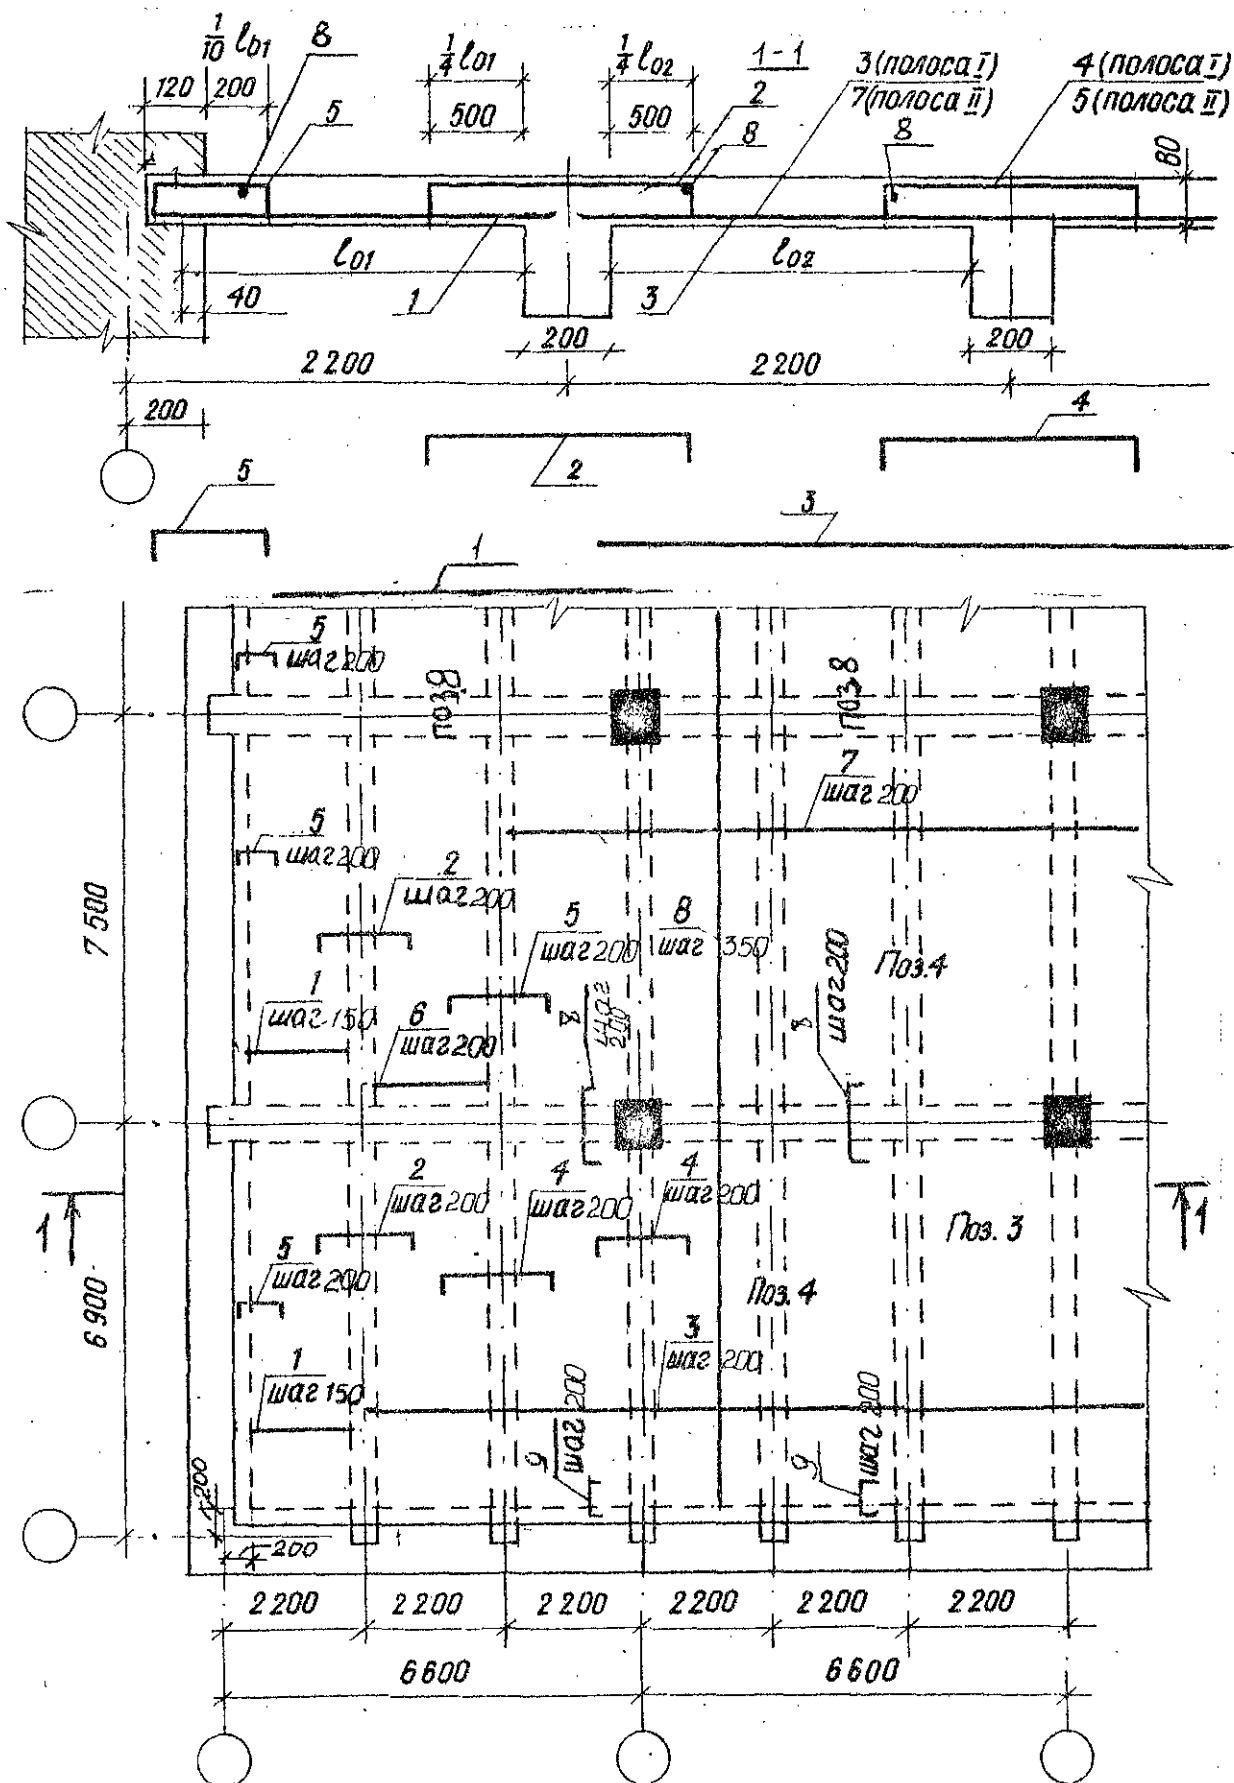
Армирование плиты вязаными сетками из гладких стержней без отгибов
